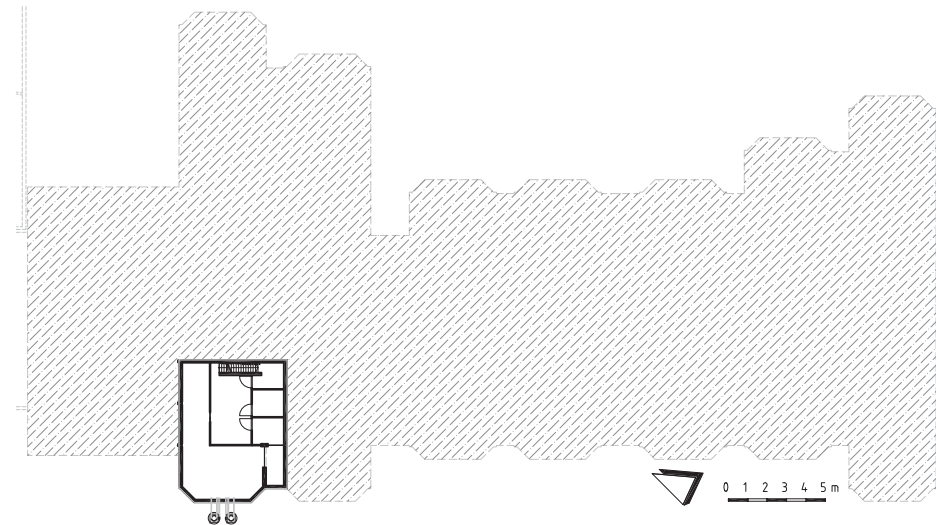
Grundriss Kellergeschoss Hauptschule Mitterdorf i. M.
